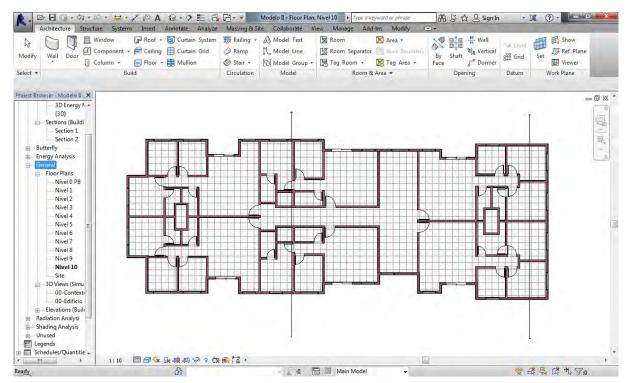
Planta tipo del Caso II modelada en Revit. Elaboración propia.
